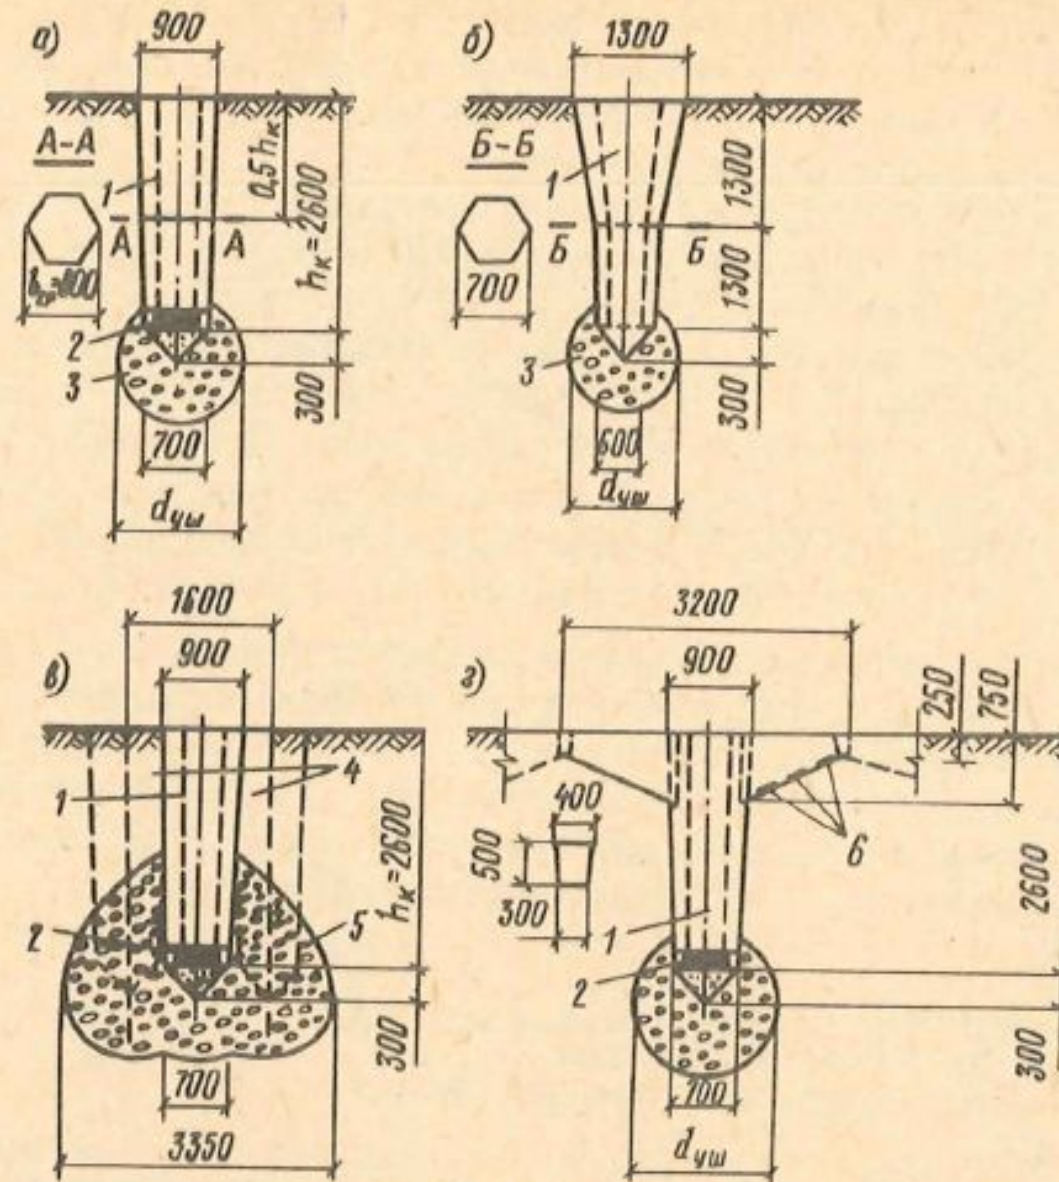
У.19. Конструкции опытных свайных фундаментов в вытрамбованных котлованах
